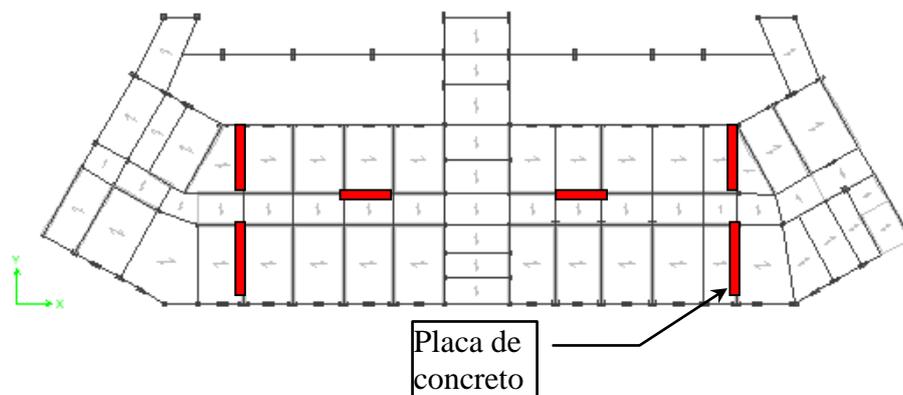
Esquema de reforzamiento con muro de concreto en bloque C2
